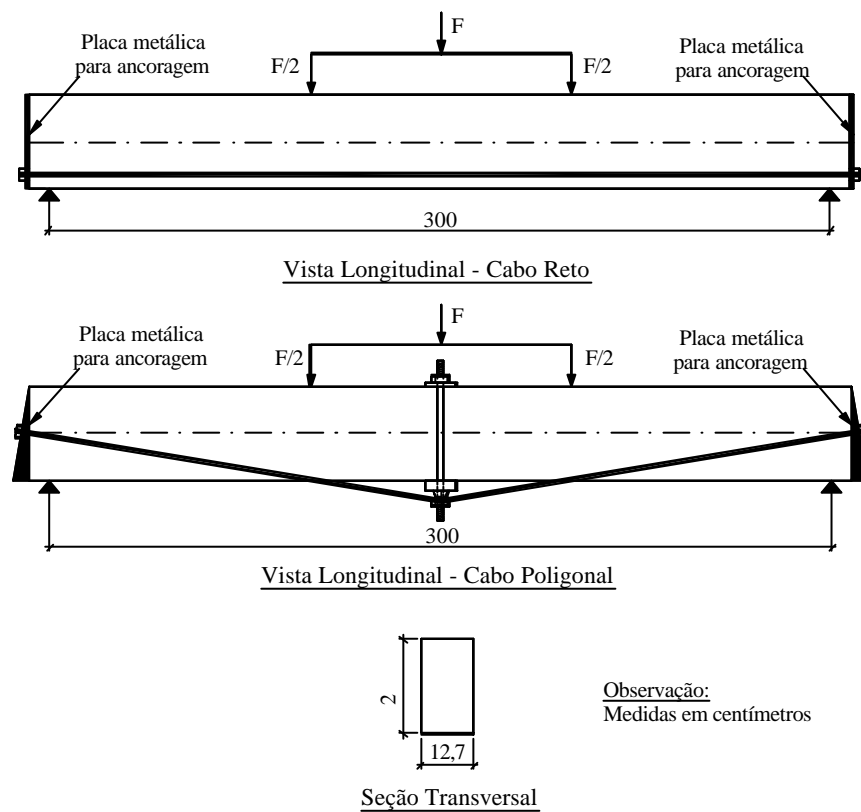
Vistas longitudinais e seção transversal das vigas ensaiadas por HARAJLI (1993)
